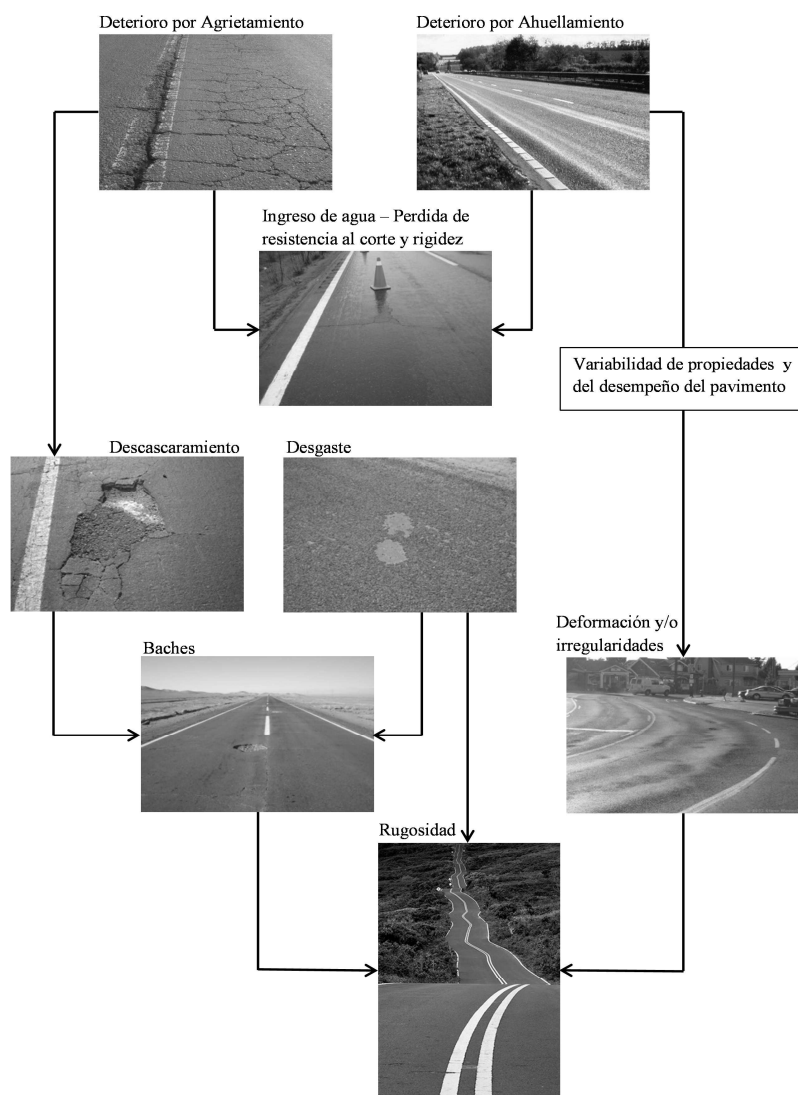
Mecanismo de falla e interacción de deterioros en pavimentos flexibles.
